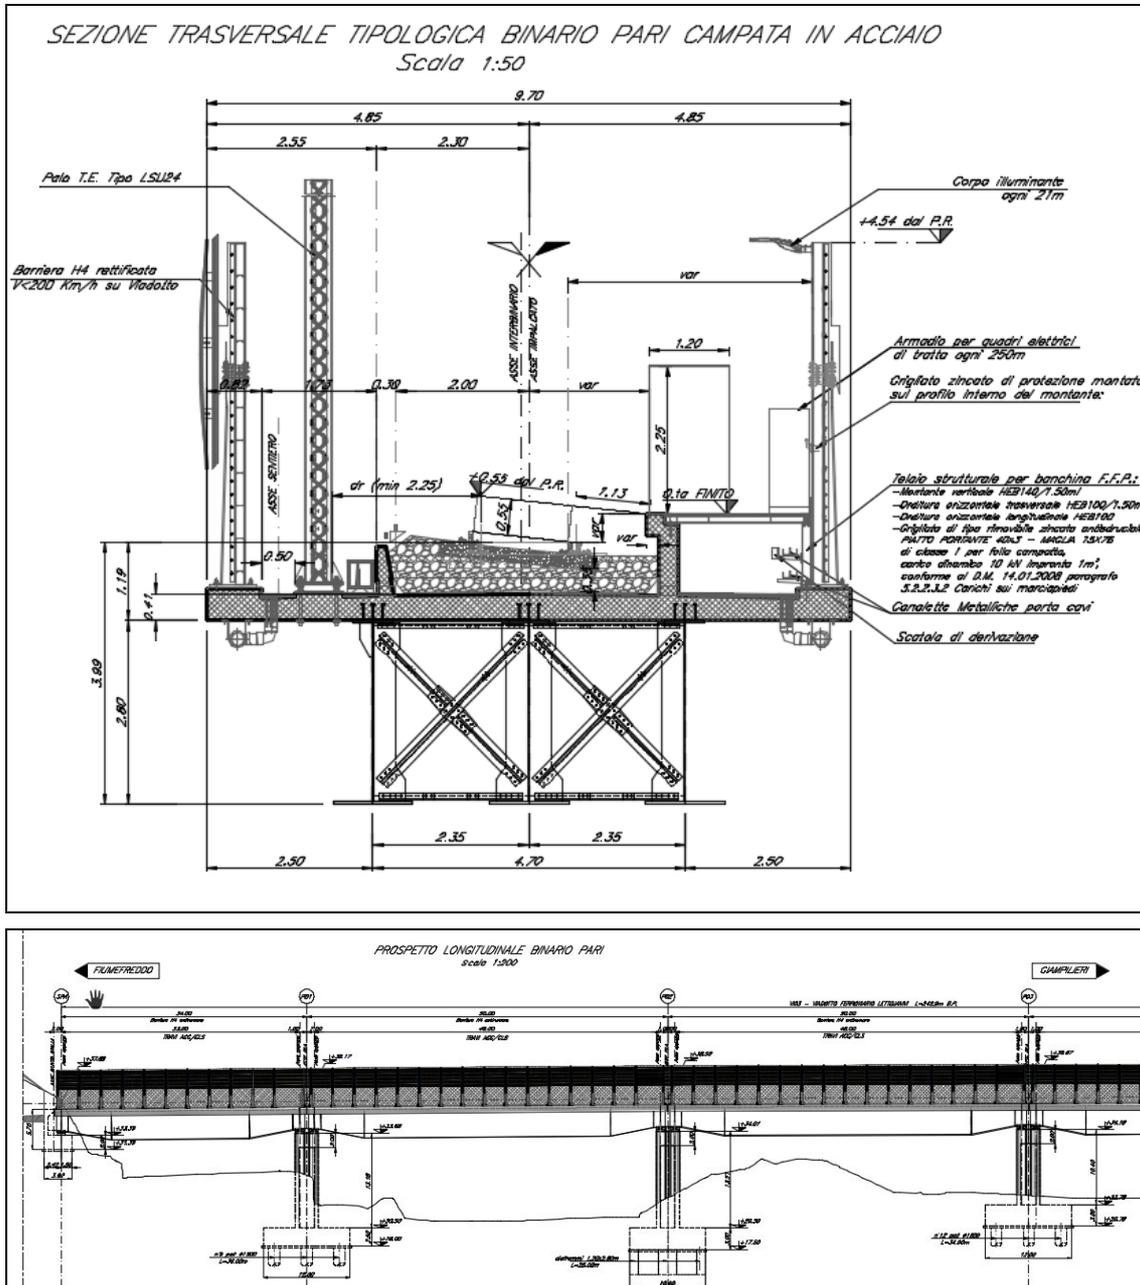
Viadotto Letojanni: sezione trasversale e prospetto binario pari
